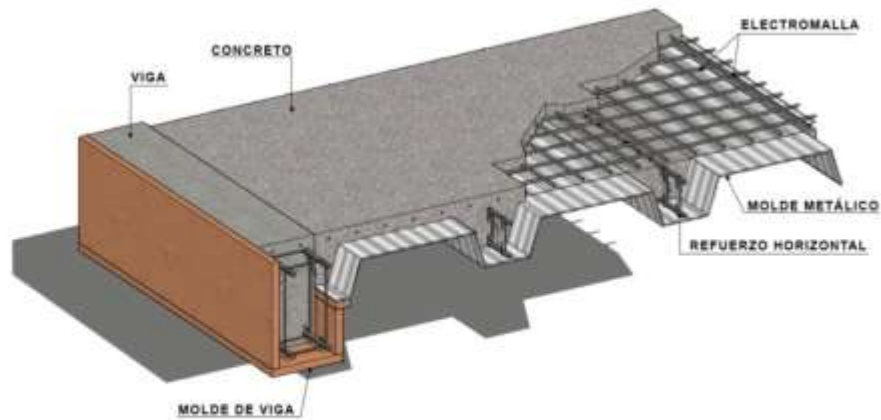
LOSA APOYADA SOBRE VIGAS EN UNA DIRECCIÓN
